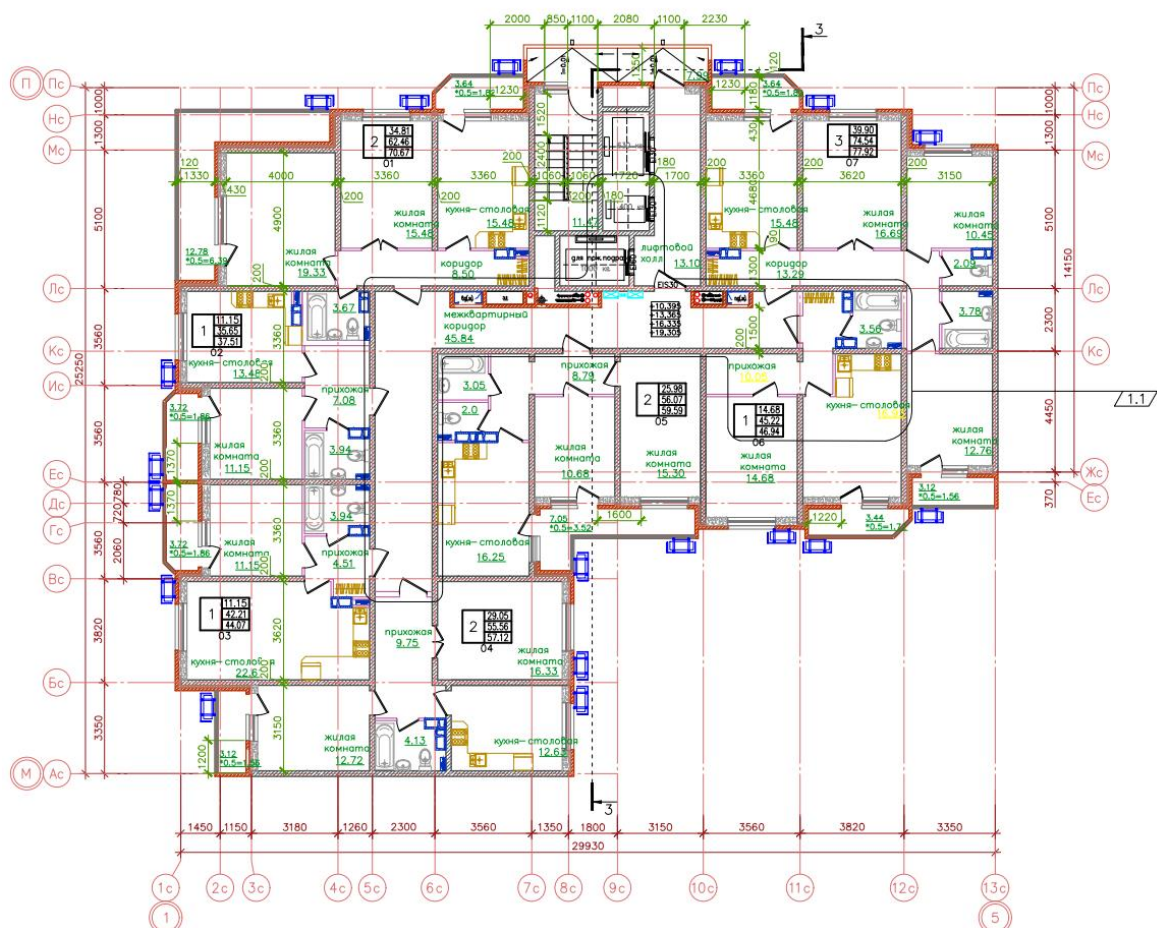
Типовой план 4-7 этажа БС-5 ЖК URAL
